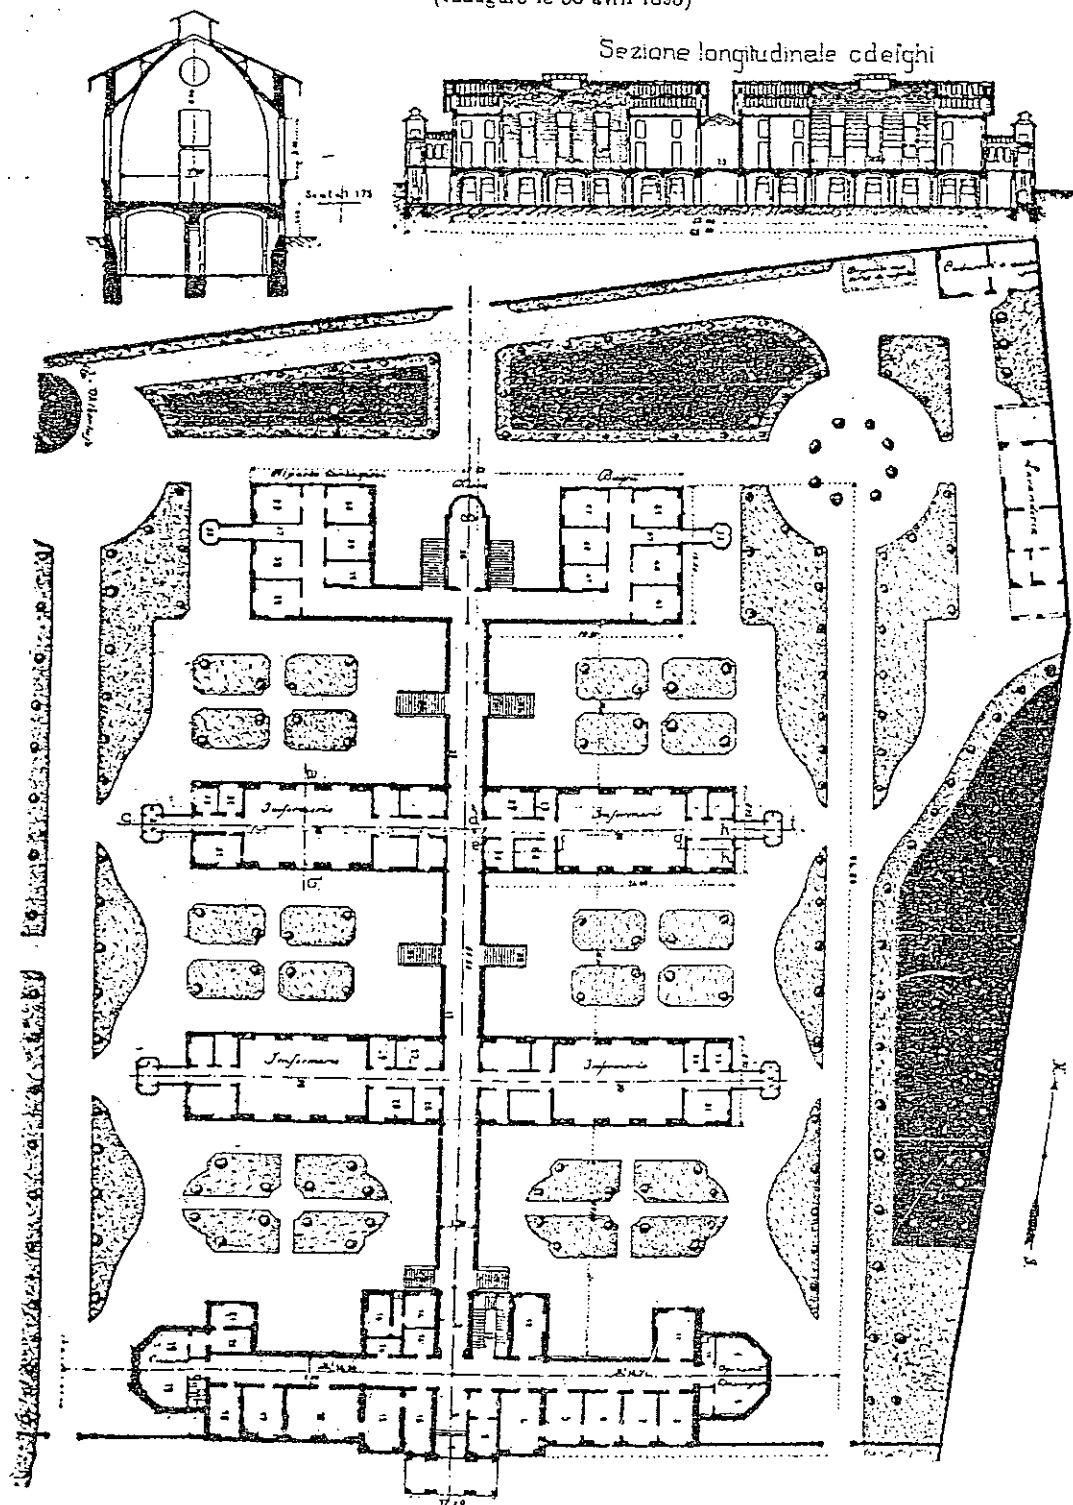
h. — Coupes transversale et longitudinale, plan général.
